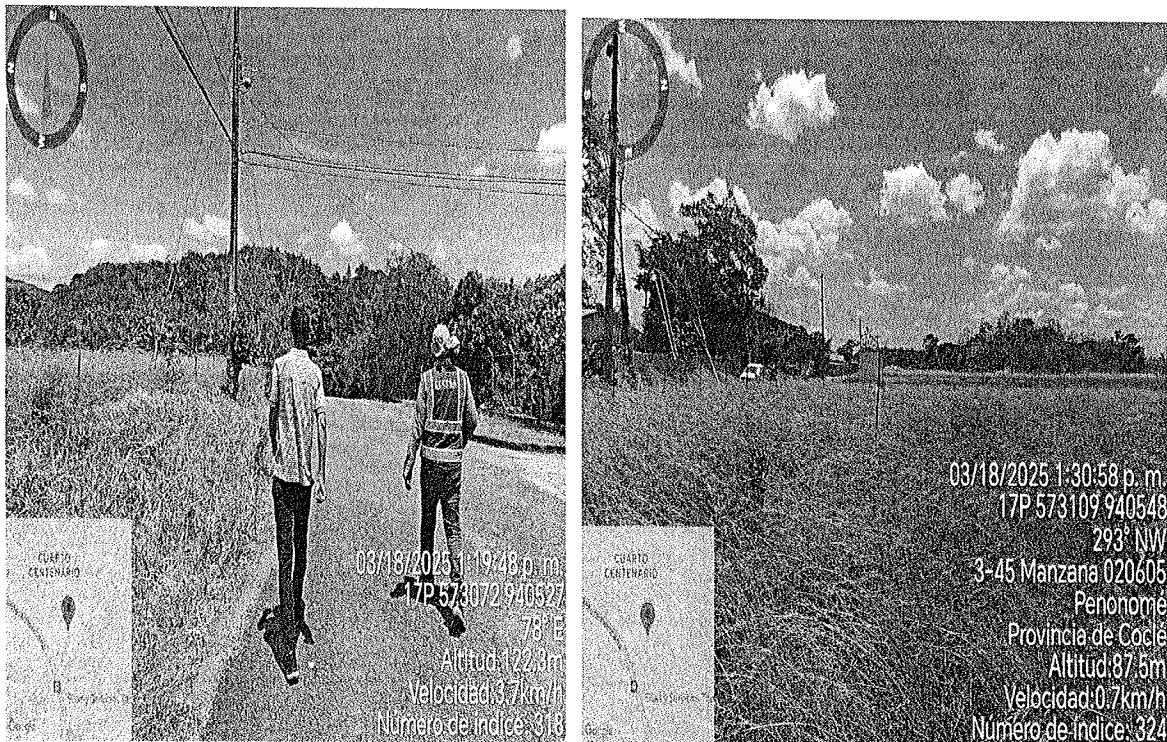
,2, 3 y 4 área propuesta para el desarrollo del proyecto
